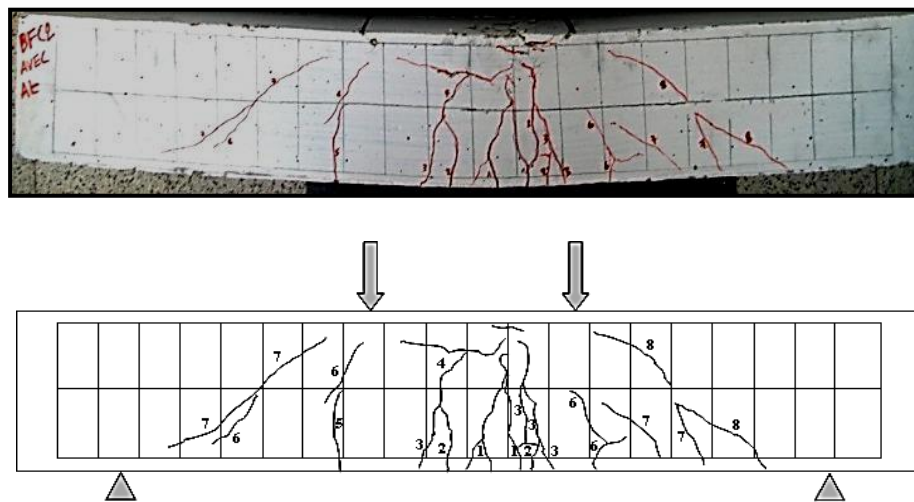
Destruction et fissuration finale de la poutre PBFC2 avec At.
